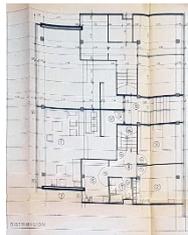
Planta primera dúplex Instalaciones B-2-4. 1964. Fuente: Archivo Municipal da Coruña
